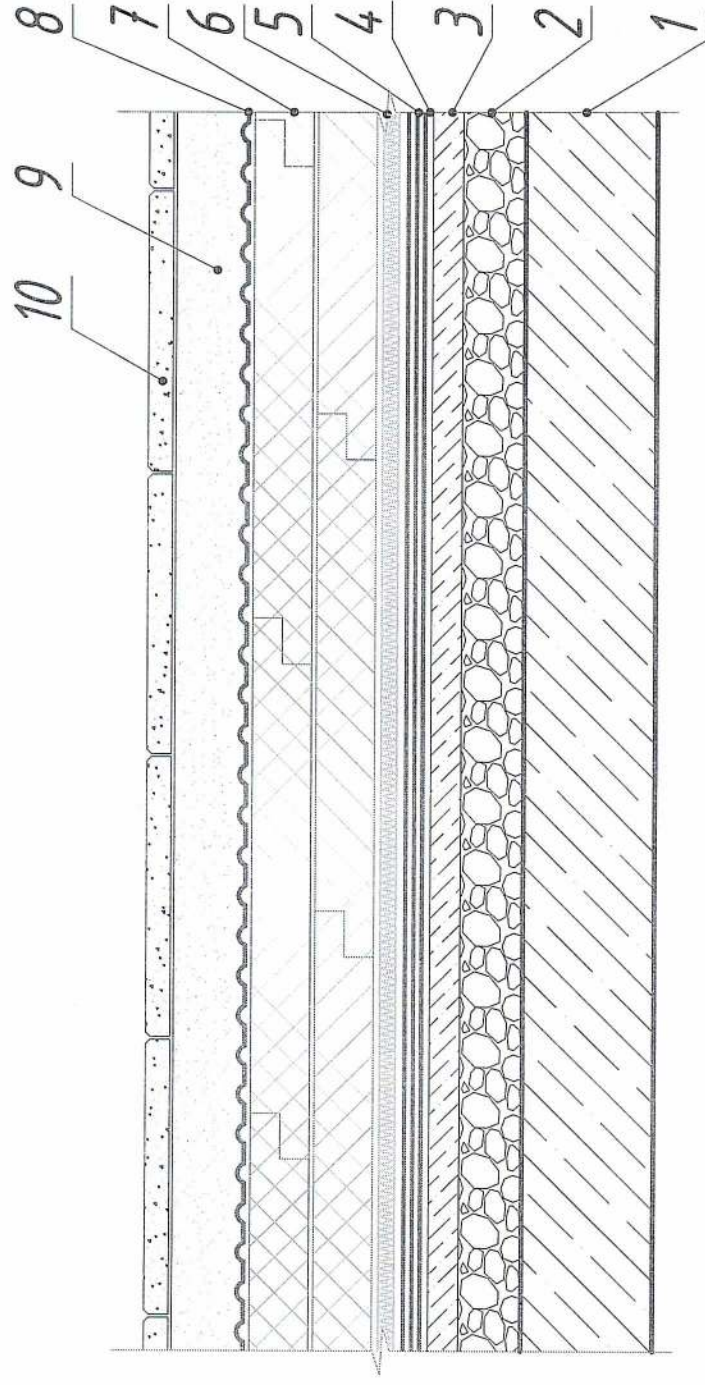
Принципиальная схема конструктивного исполнения бесчердачного покрытия выполняемого по железобетонному основанию (инверсионная эксплуатируемая крыша под пешеходную нагрузку)
